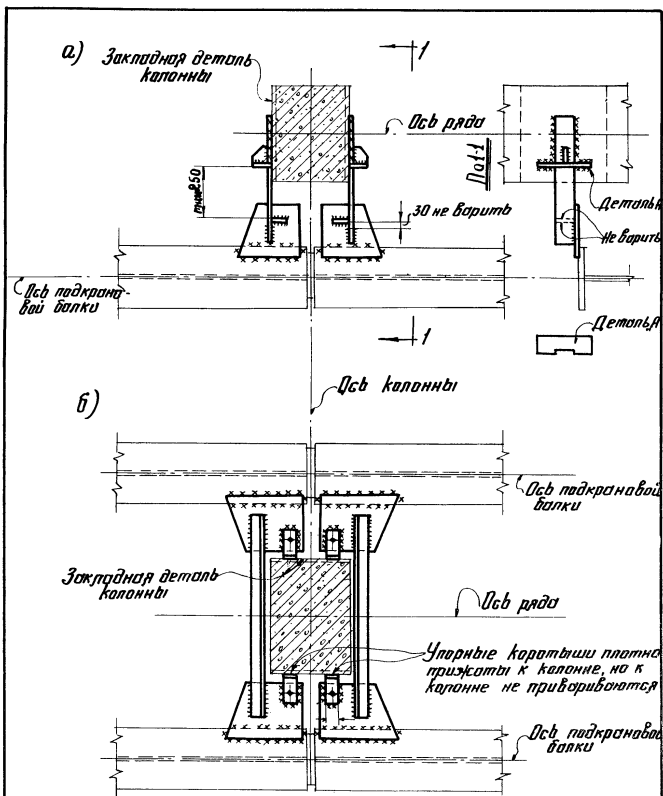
Крепление верхнего пояса разрезных подкрановых балок к железобетонным колоннам при отсутствии тормозного устройства:
